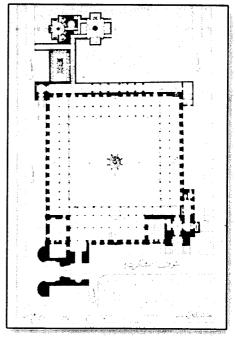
جامع سامراء (مسقط أفقي) عن : كريزول
